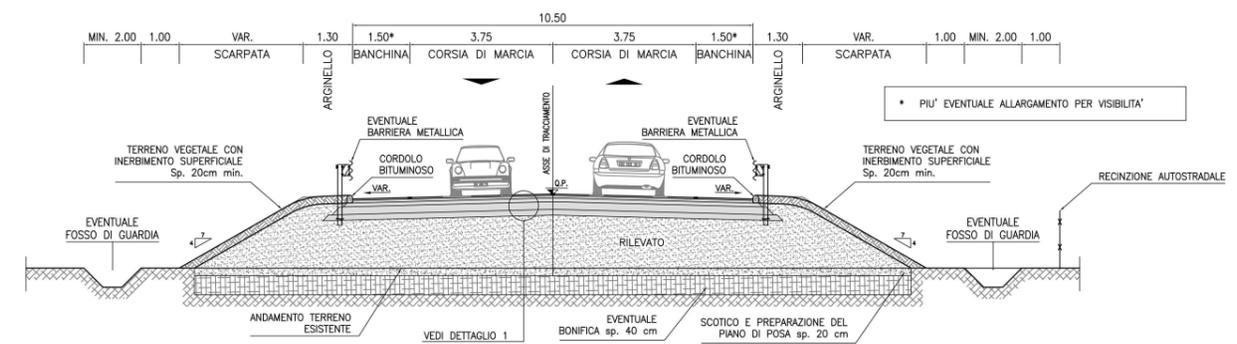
Sezione tipo – Rampa di svincolo bidirezionale
